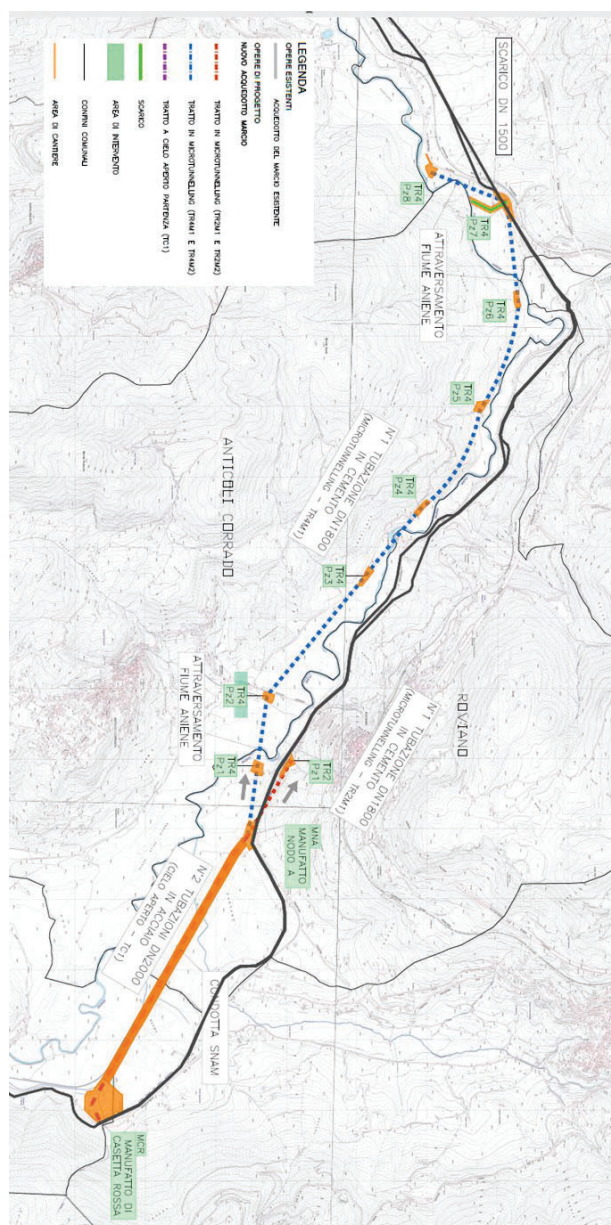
Planimetria del tracciato di progetto suddiviso nei 3 lotti funzionali.
